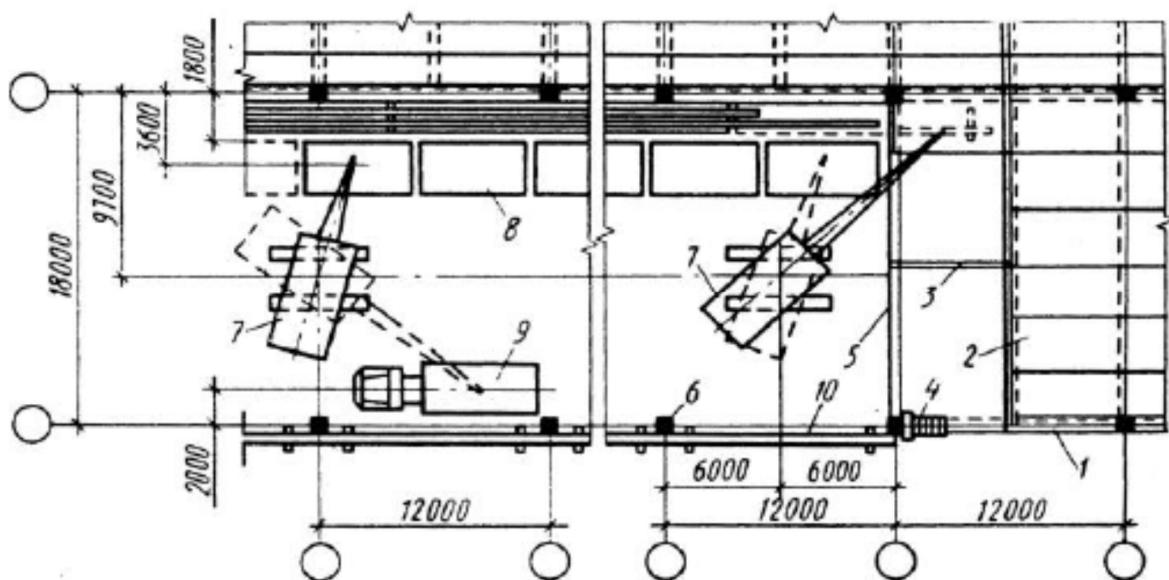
Схема выгрузки, раскладки элементов и монтажа покрытия в пролетах 18 м, с шагом колонн 12 м, ферм 6 м продольным методом: 1 - временное ограждение; 2 - смонтированное покрытие; 3 - инвентарная распорка для временного крепления ферм; 4 - лестница-площадка приставная; 5 - стропильная ферма; 6 - колонна; 7 - кран; 8 - штабель плит; 9 - транспортное средство; 10 - подстропильная ферма.
